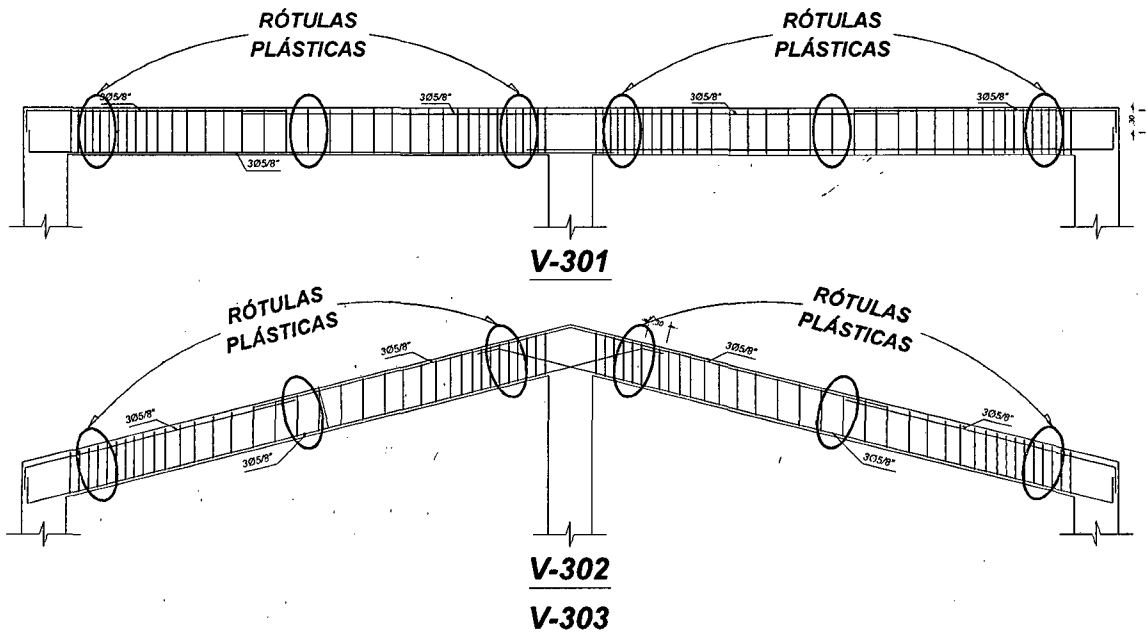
Ubicación de las rótulas a analizar en las vigas V-301, V-302 y V-303
